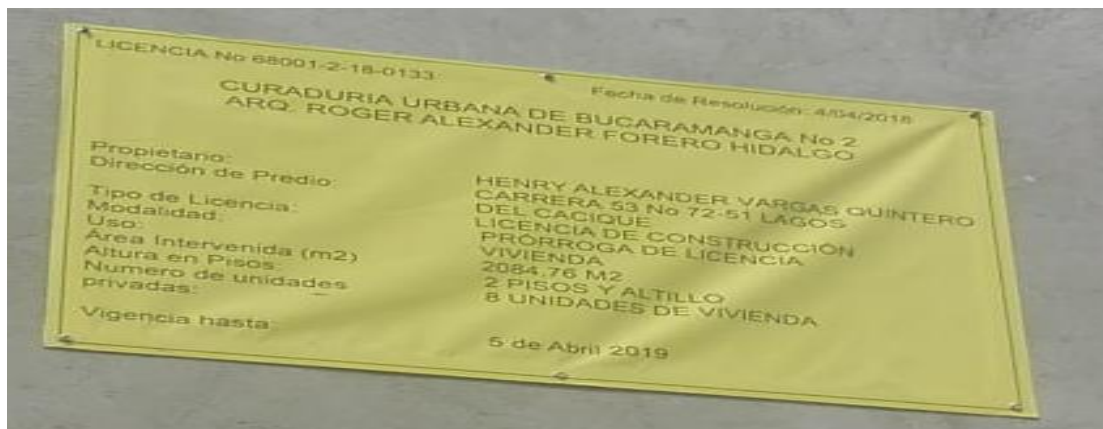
Licencia de construcción. *Proyecto AVANTI.
